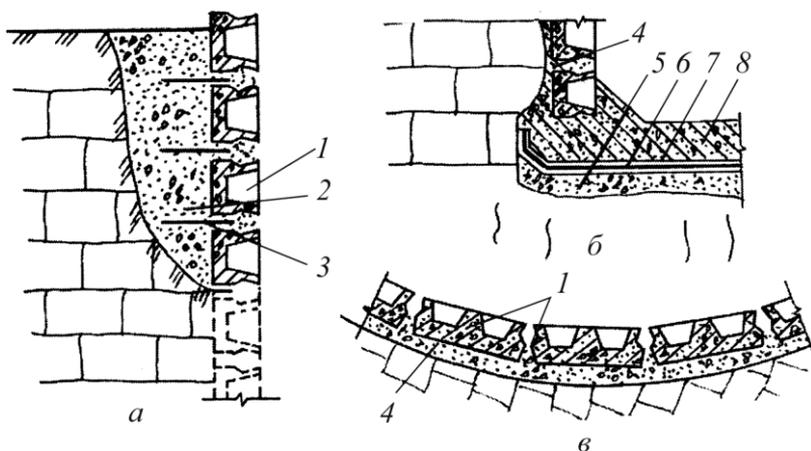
Конструкция стен сооружения, возводимого методом подрачивания: а – воротник; б – сопряжение с дном; в – фрагмент плана: 1 – тьюбинги; 2, 4 – тампожаж; 3 – выпуски арматуры; 5 – бетонная подготовка; 6 – гидроизоляция; 7 – защитная стяжка; 8 – железобетонное днище
